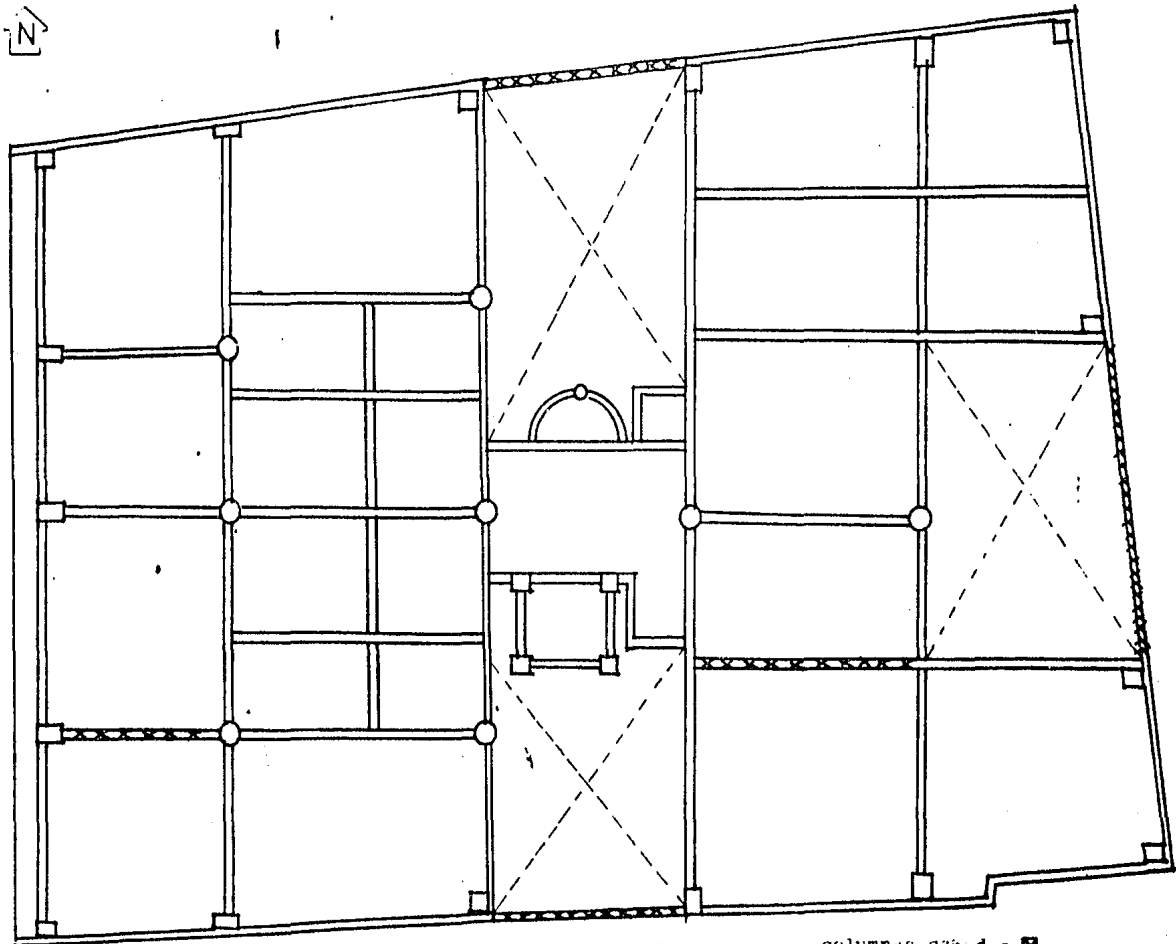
b. Daños en los elementos estructurales del nivel 3
